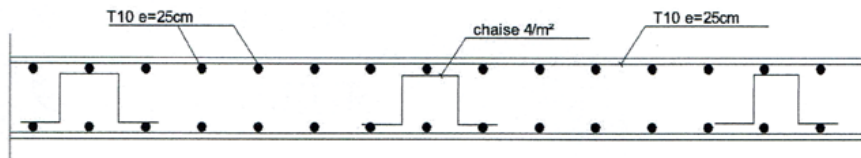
Schéma de ferrailage de la dalle pleine.
